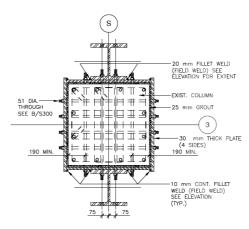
Puntal de transferencia soldado a placa de acero a cada lado de la columna. Esquema – corte transversal.
